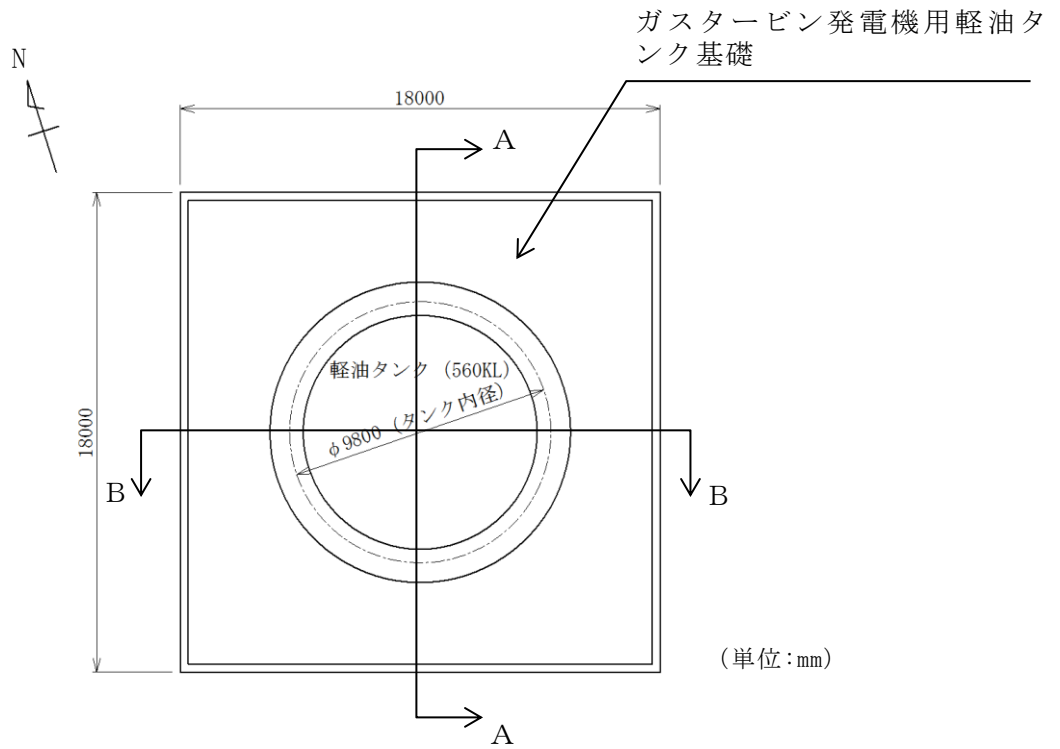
ガスタービン発電機用軽油タンク基礎 平面図
